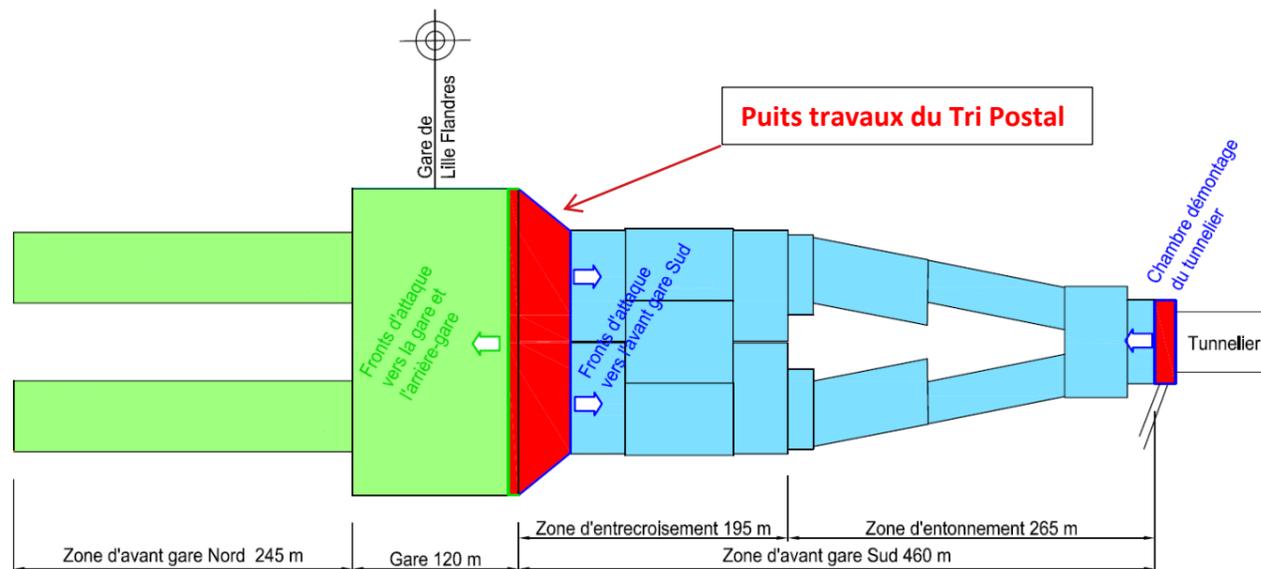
Phasage général des travaux de réalisation des ouvrages du secteur de la gare de Lille-Flandres
